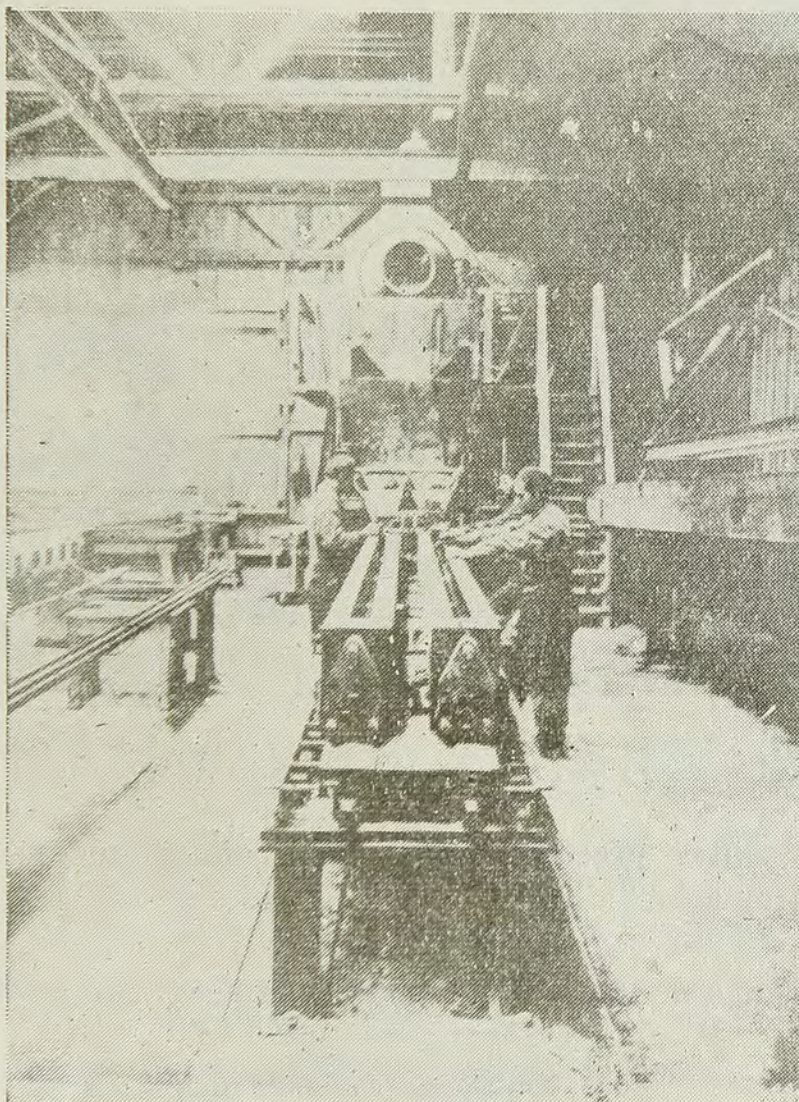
Fábrica de viguetas en Orleans. Concretadura de 2 vigas en sus moldes con las armaduras pretendidas.
